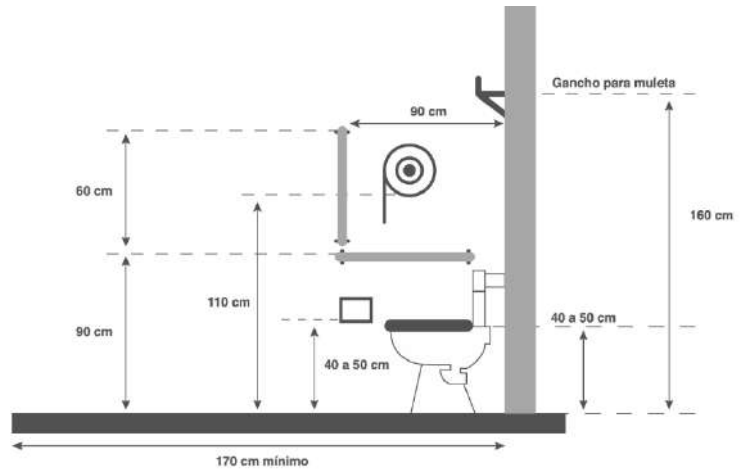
Barras de apoyo. Fuente: (Gobierno del Estado de México, 2024)
